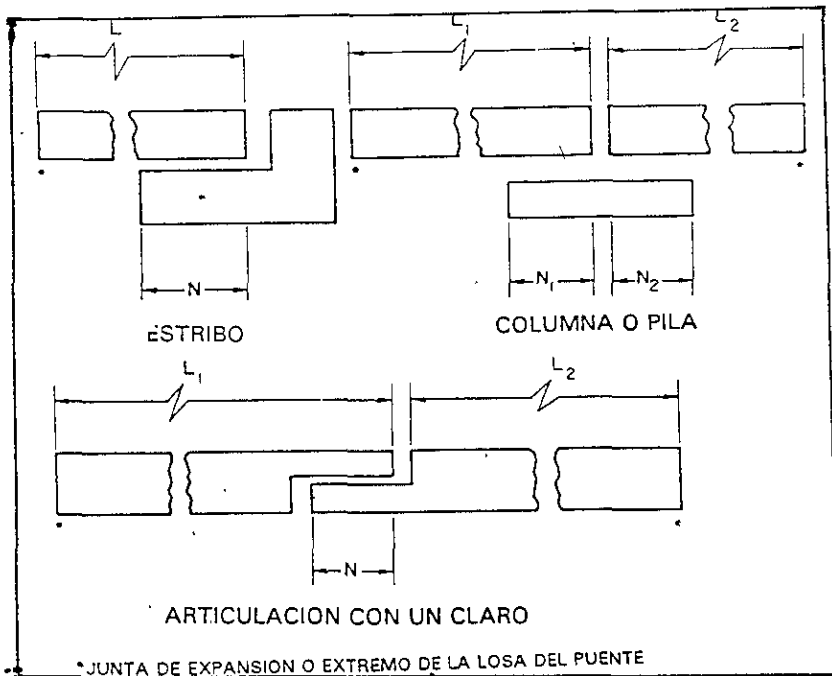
Longitud de cubierta de puente para cálculo del ancho de asiento
